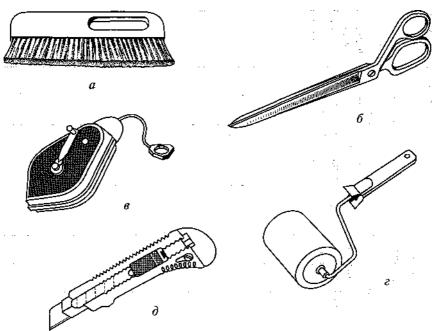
Инструменты для обойных работ: a — щетка; δ — обойные ножницы; ϵ — разметочный шнур; ϵ — ролик для прокатки кромок полотен; δ — нож
